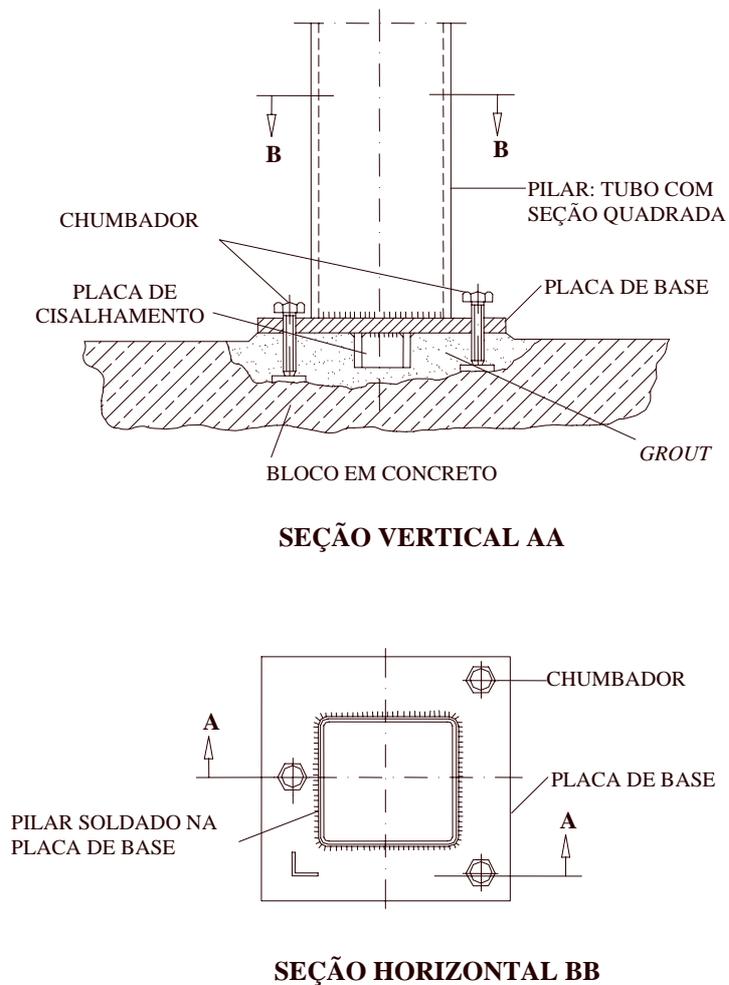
Detalhe de fixação rígida do pilar e placa de base.
